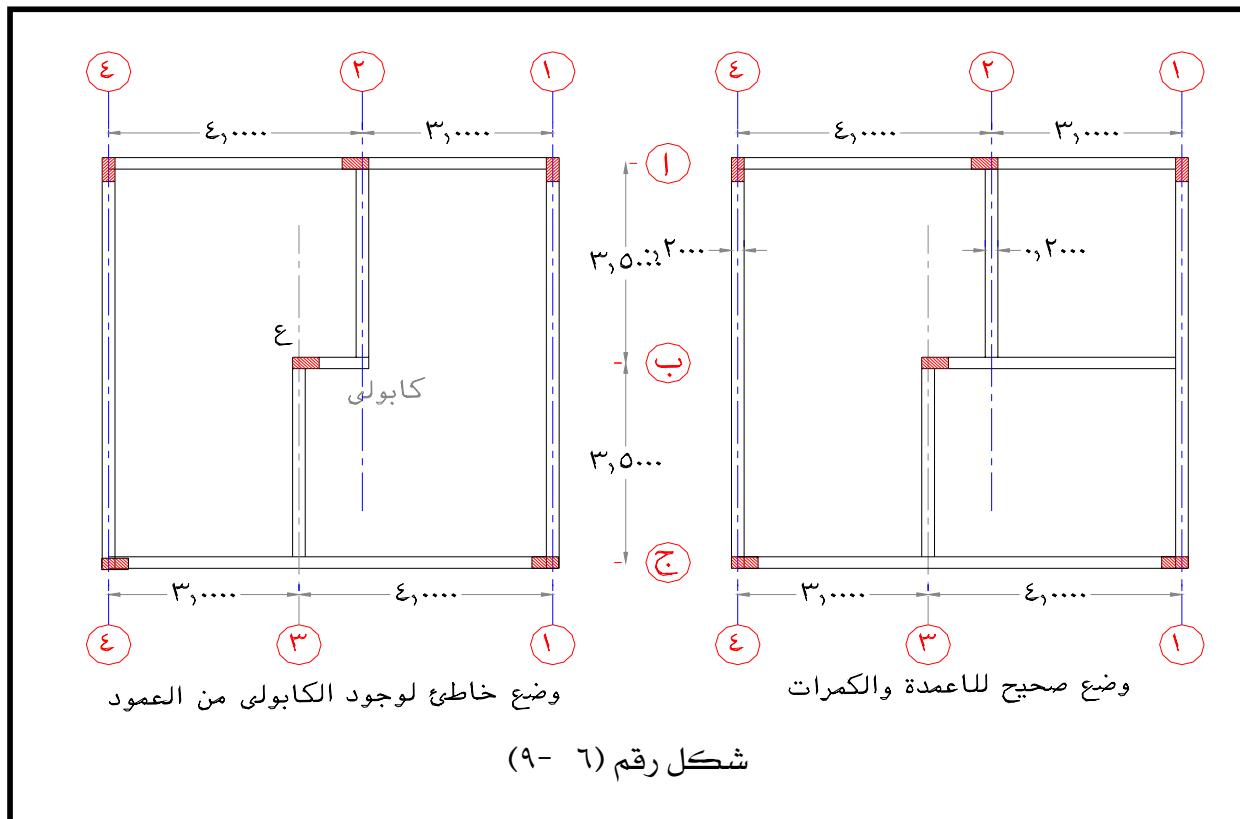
مكان الأعمدة في المسقط الأفقي
